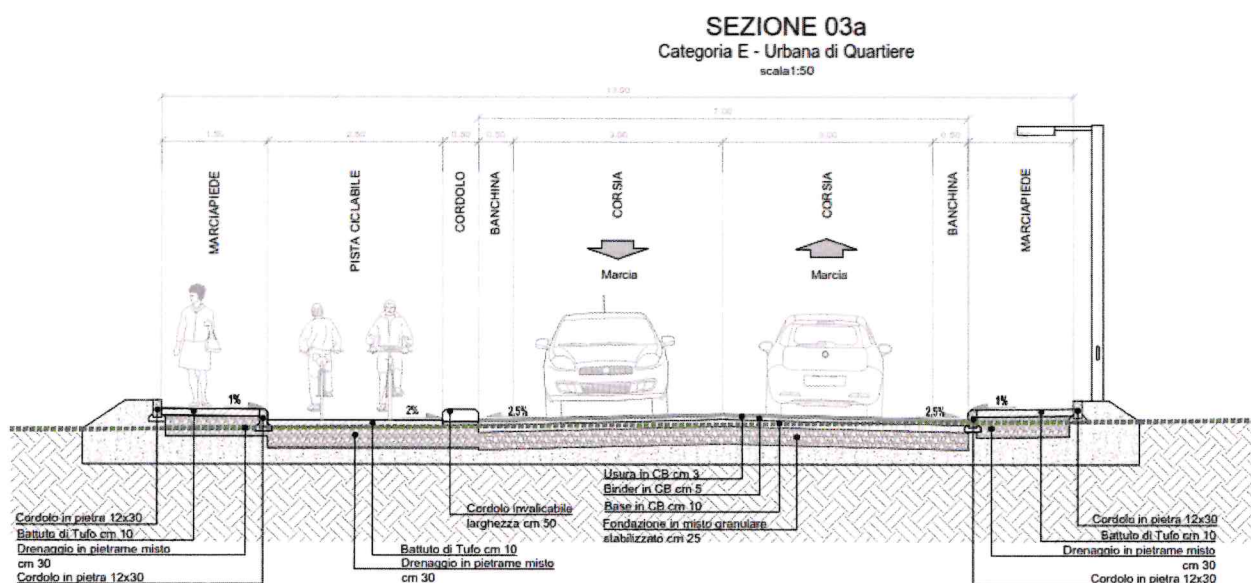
Strada di collegamento Via Roma – Via E.Bonavoglia- Sezione Tipo Stradale
